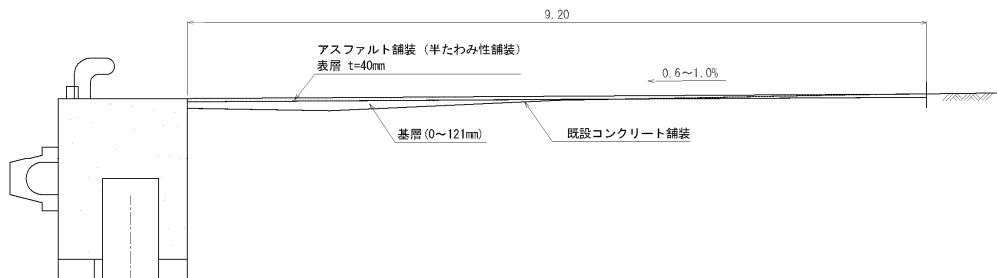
69 No. 1 南公共ふ頭 H 岸壁 (-10m) 断面図 (復旧後)
